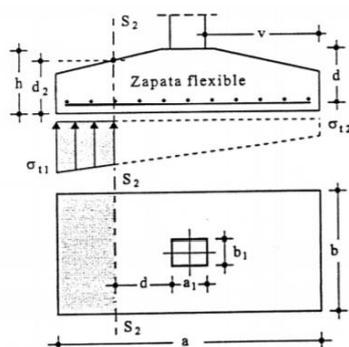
Dimensionado a cortante de una zapata. (CTE DB SE-C, 2006)
